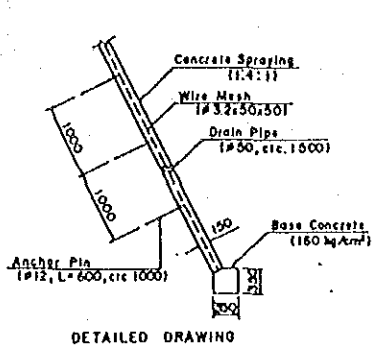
(1) コンクリート吹付 (タイプ 1)
